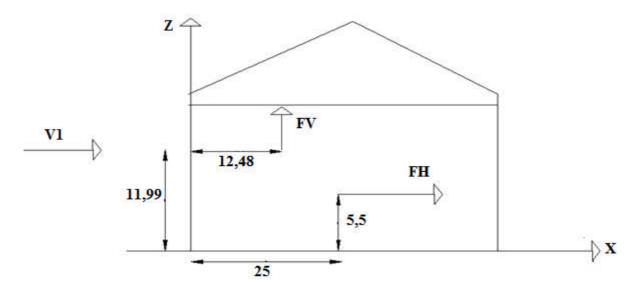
Résultantes des forces horizontale et verticale sur la façade latérale gauche et droite avec surpression intérieure
